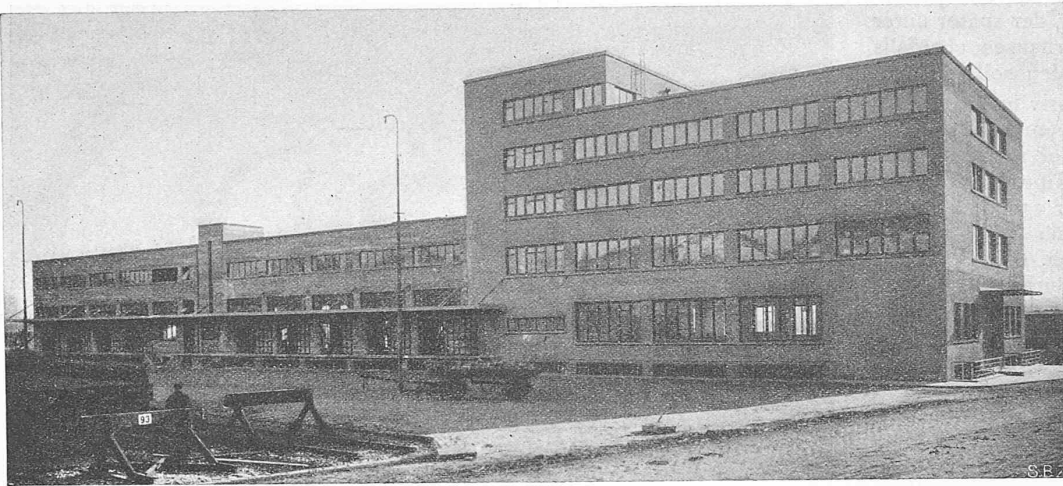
Ansicht des Hauptgebäudes mit Lagerhaus der Reichsbahndirektion Stuttgart im ersten Teilausbau.
